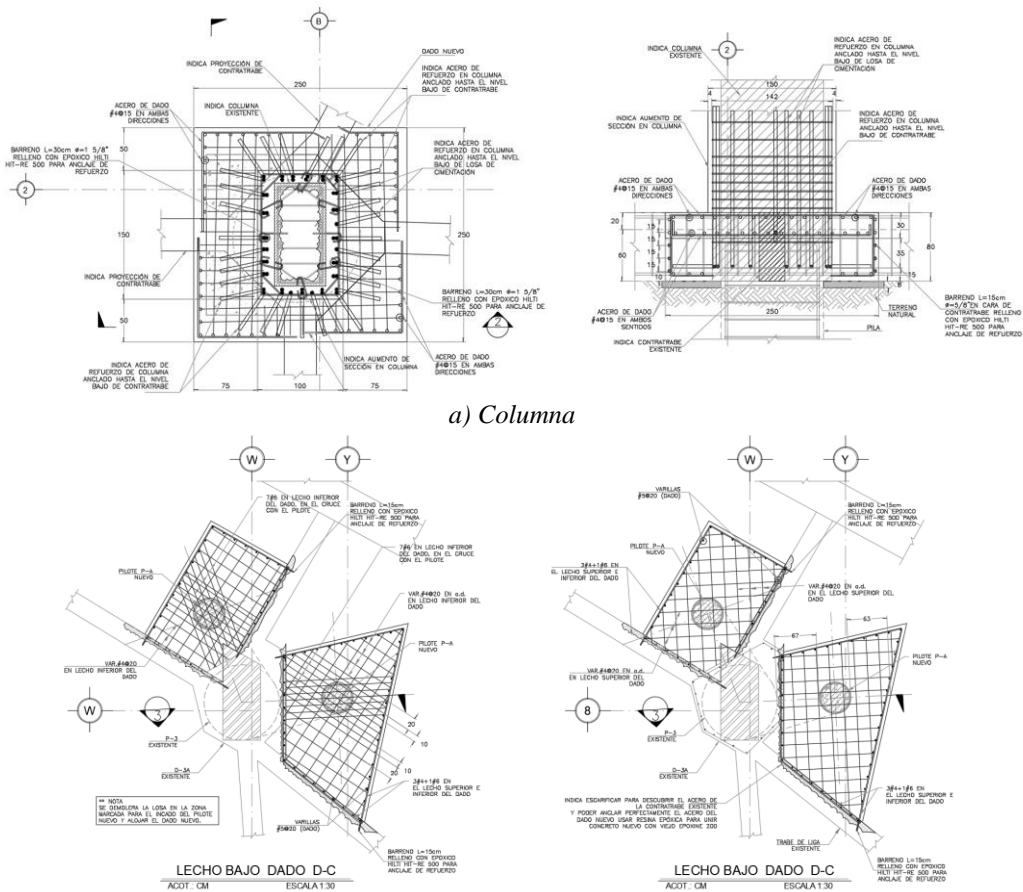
Refuerzo en columnas perimetrales y dados de cimentación.
